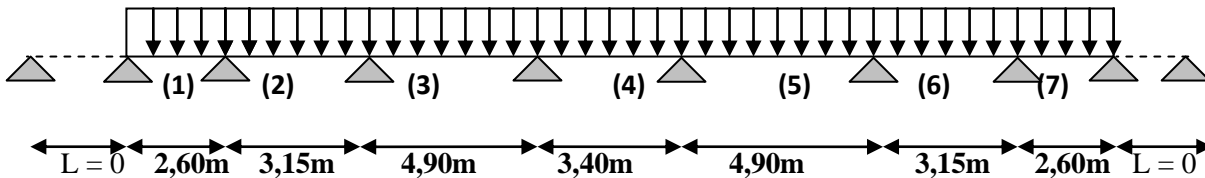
Schéma statique de la poutrelle :
